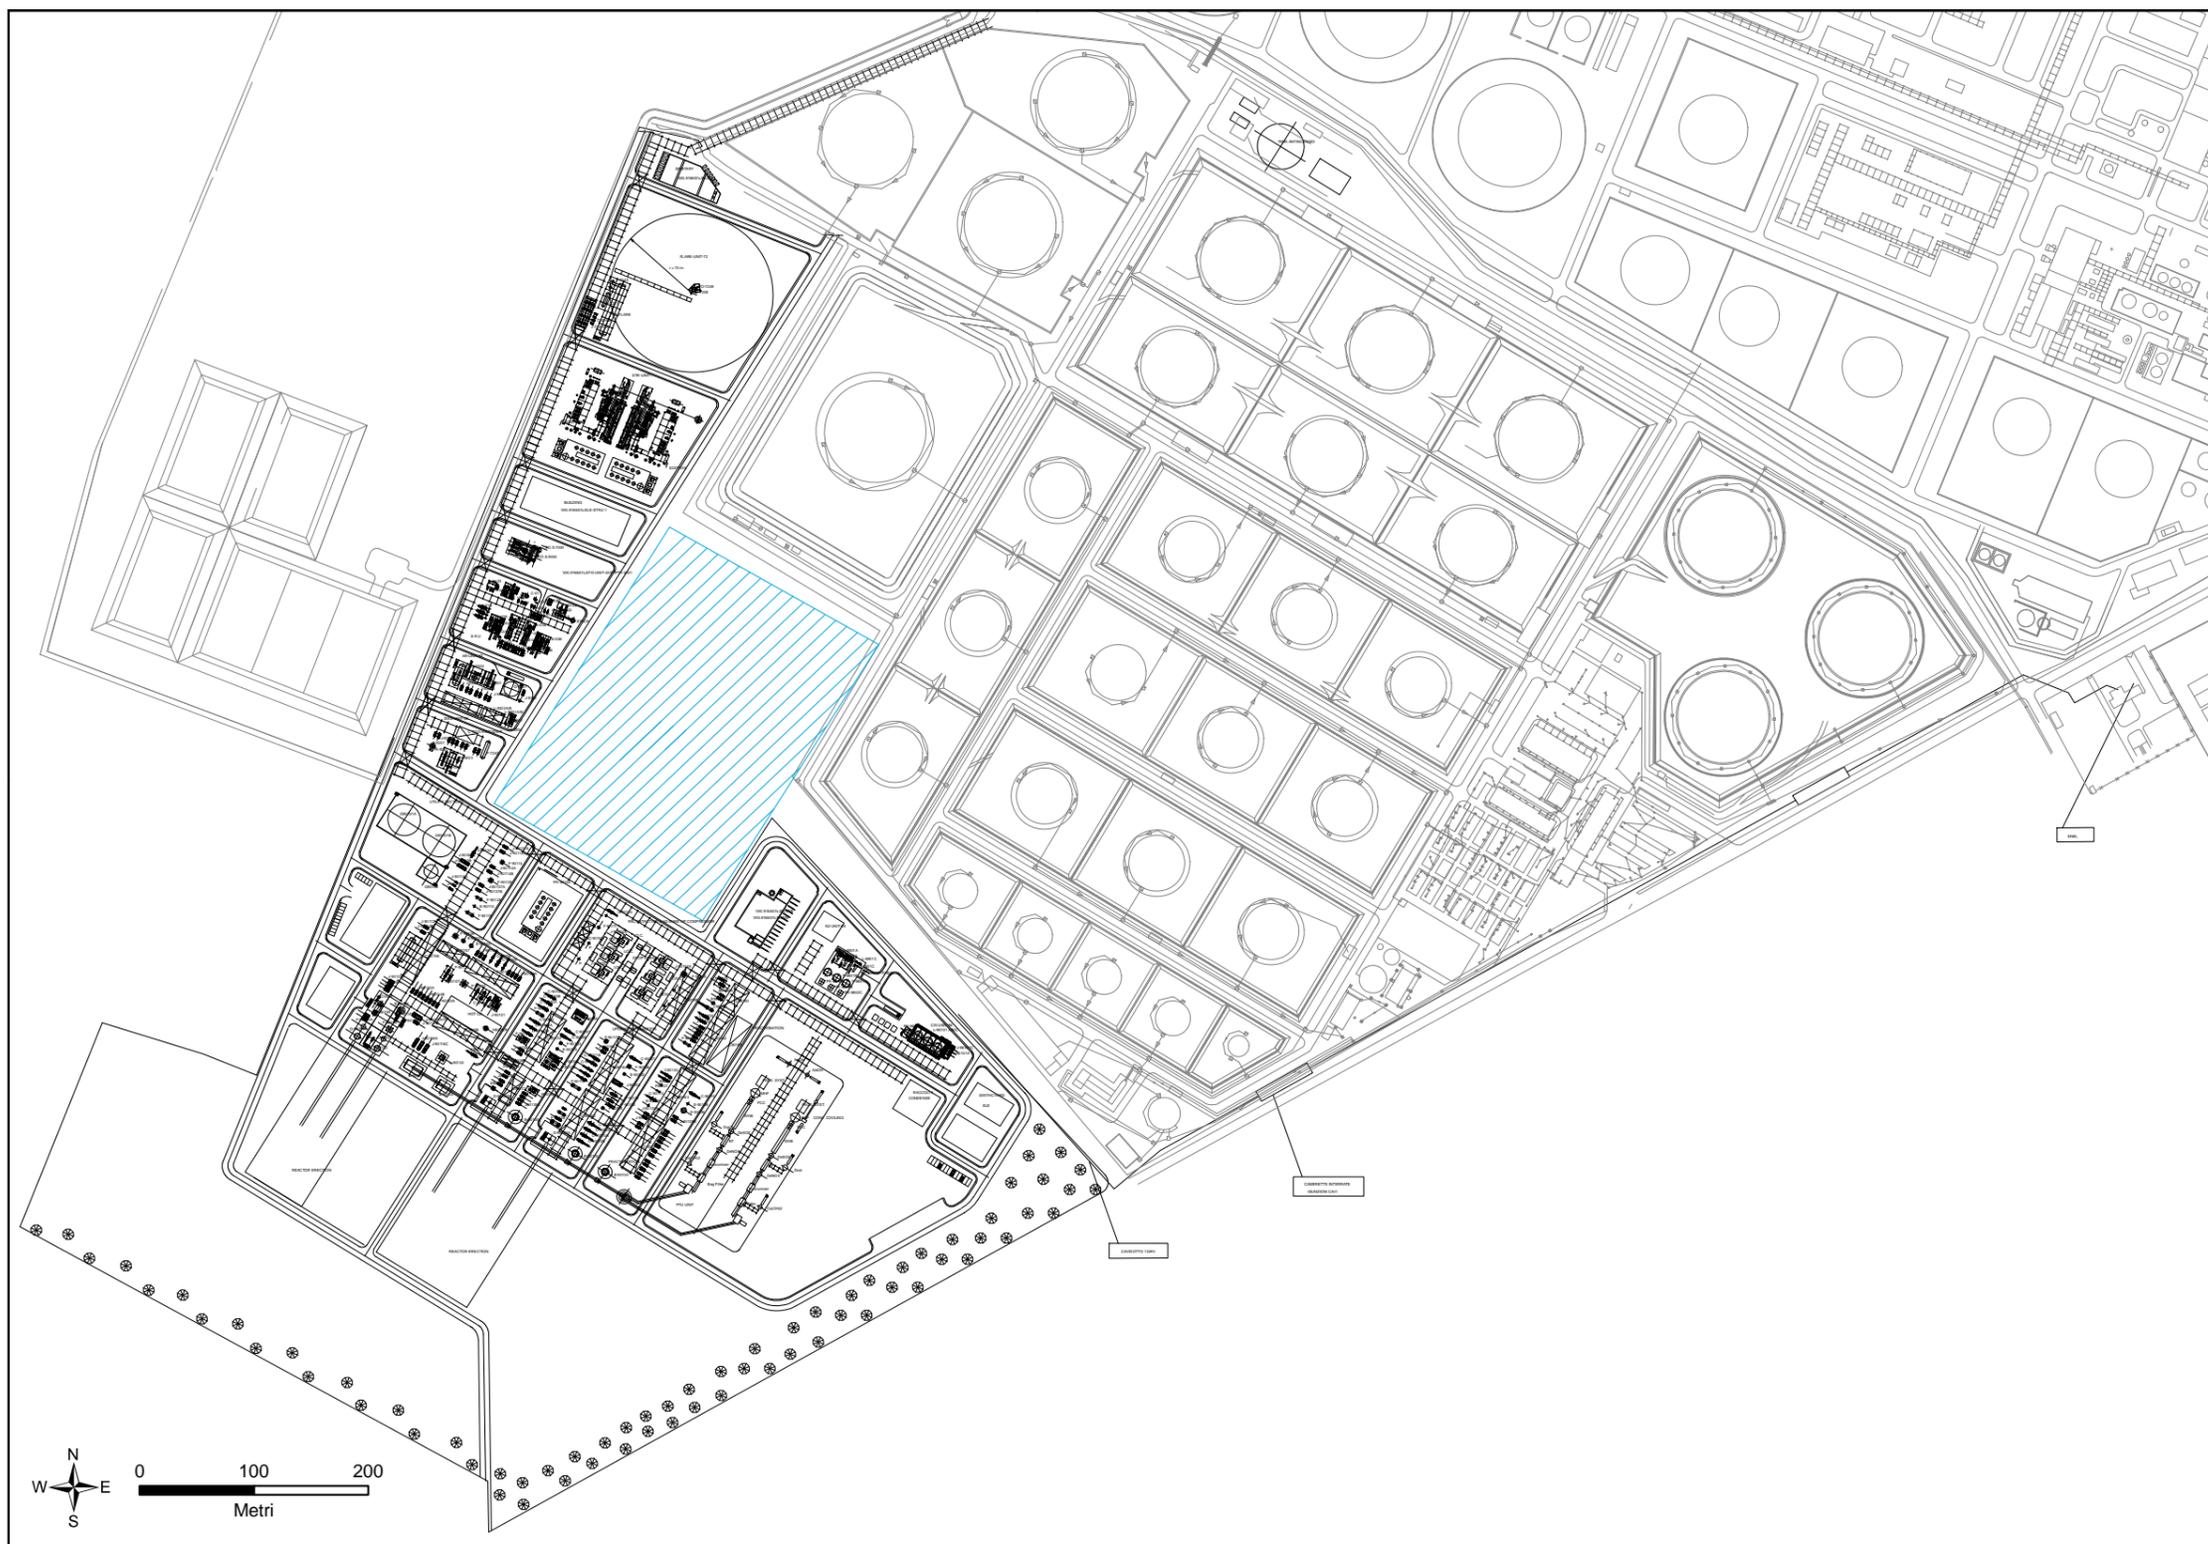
A: Planimetria generale del nuovo progetto "Impianto EST e Unità associate"
